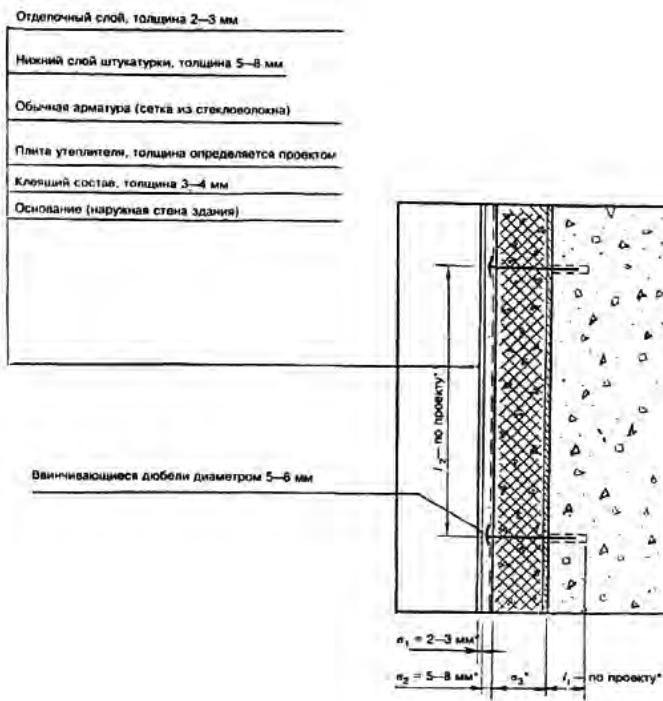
Фрагмент наружной теплоизоляции здания с тонкой штукатуркой по утеплителю
